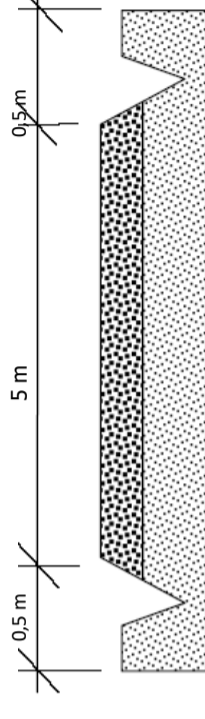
Exemple de vue en coupe d'une piste d'accès (Source : VESTAS)
